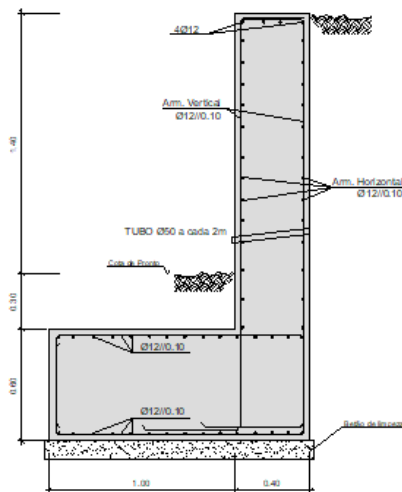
Pormenor de Ligação Sapata /Muro de Suporte
